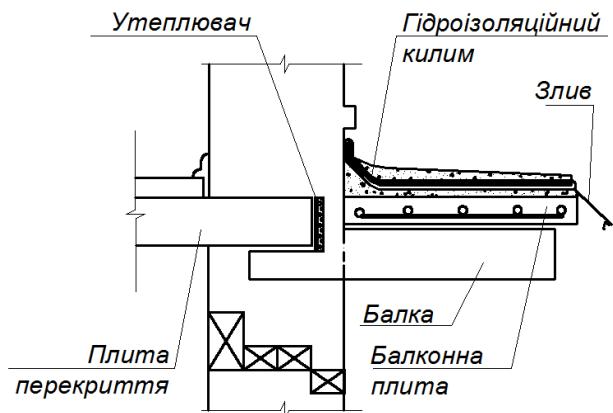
Конструкція балконної плити, влаштованої по залізобетонним балкам
